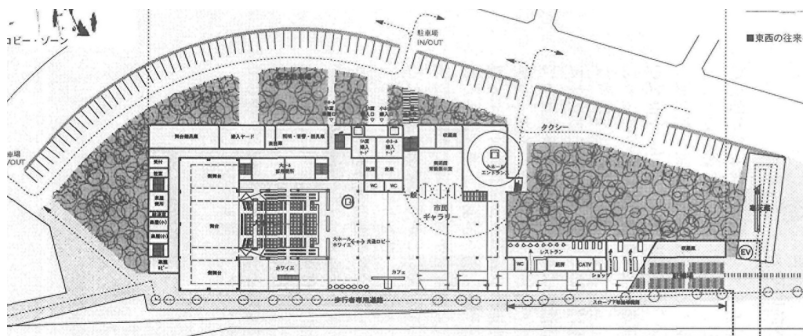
Der vorgeschlagene Grundriss bei der Architekturauswahl (ebd., 210)
